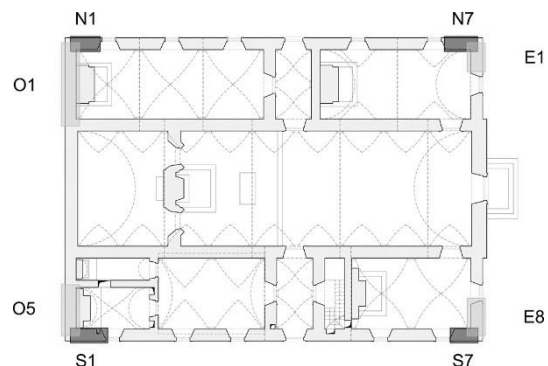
Pianta riportante la localizzazione degli elementi indagati.
